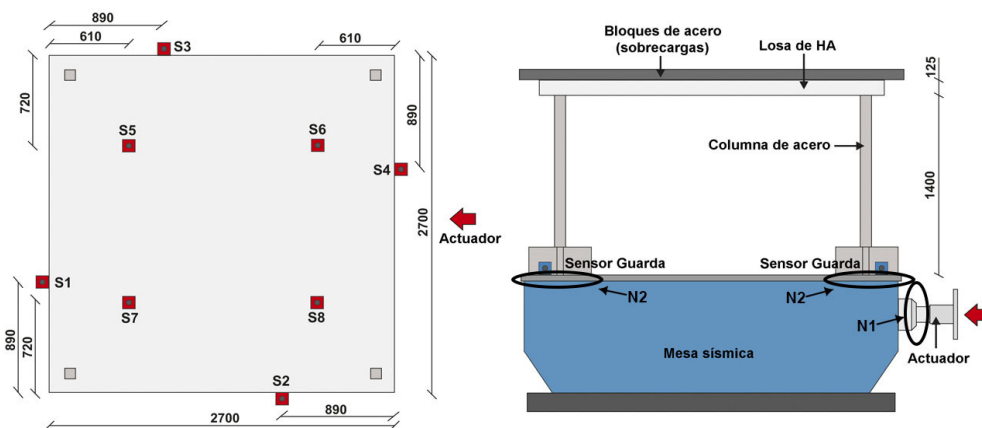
Ubicación de los sensores y las fuentes de ruido indeseable en el modelo de ensayo de la losa de HA con pilares metálicos. Izqda.: planta. Dcha.: alzado.
